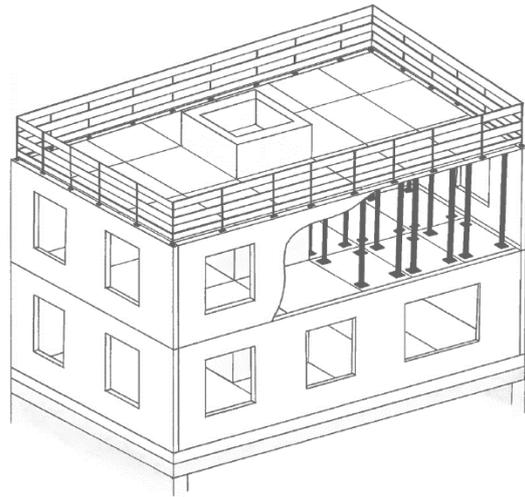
Etais pour les murs et planchers du niveau inférieur
